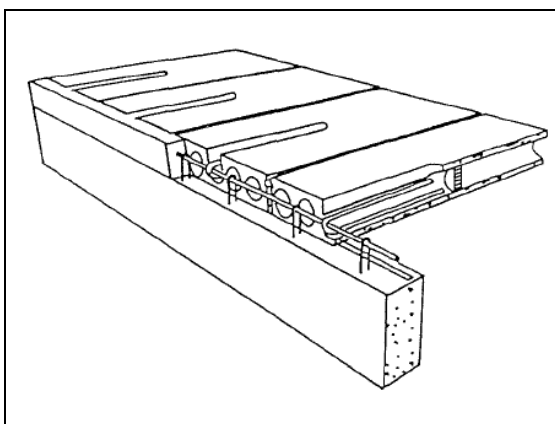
Ligação de lajes alveolares através de amarração, perpendiculares à laje de piso (Elliott, 1996)
